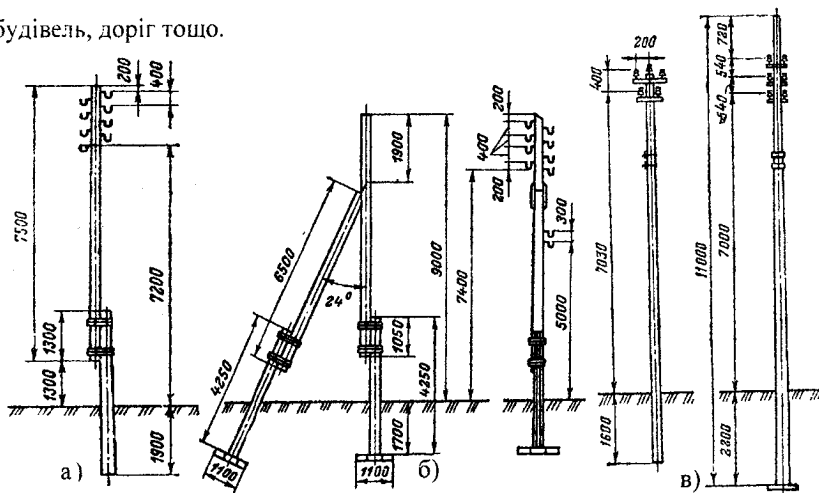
Види опор: а) – дерев'яна проміжна; б) – дерев'яна анкерна; в) – залізобетона проміжна.
